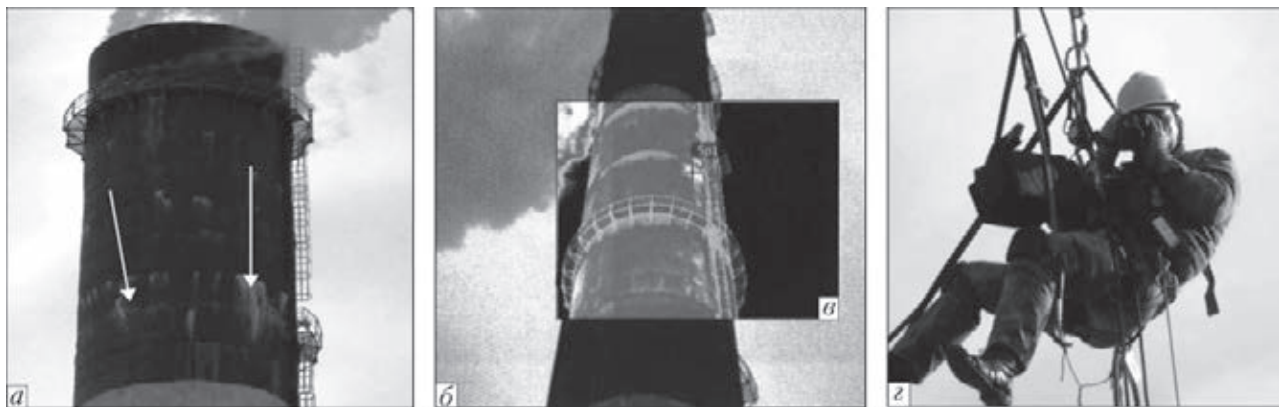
Дефекты и повреждения наружной поверхности железобетонной дымовой трубы высотой 180 м: образование наледей (обозначены стрелками) вокруг некачественно выполненных рабочих швов бетонирования с отметкой +145 м до отметки +180 м (а); определение мест протечек и образования конденсата с помощью тепловизионного метода контроля (б); термограмма (в) – на ИК-изображении зафиксированы участки повышенных теплопотерь через ограждающие конструкции. Зоны дефектных (с пустотами и полостями) участков рабочих швов трубы соответствуют по высоте трещинам во внутренней футеровке (рис. б), что приводит к конденсации влаги и последующей морозной деструкции бетона; применение метода промышленного альпинизма при обследовании ствола трубы (з)
